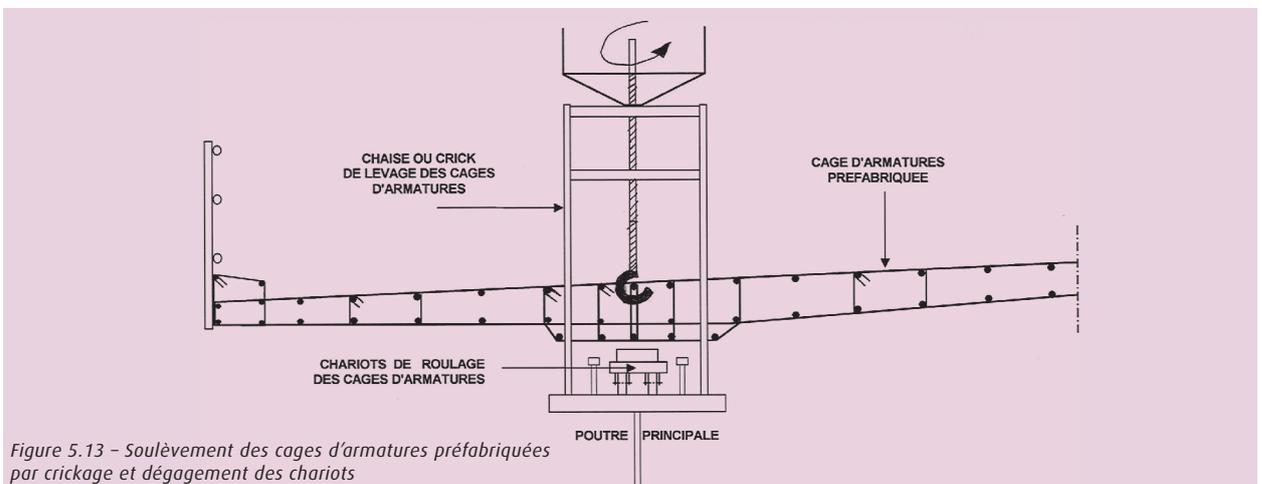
Soulèvement des cages d'armatures préfabriquées par cricage et dégagement des chariots
